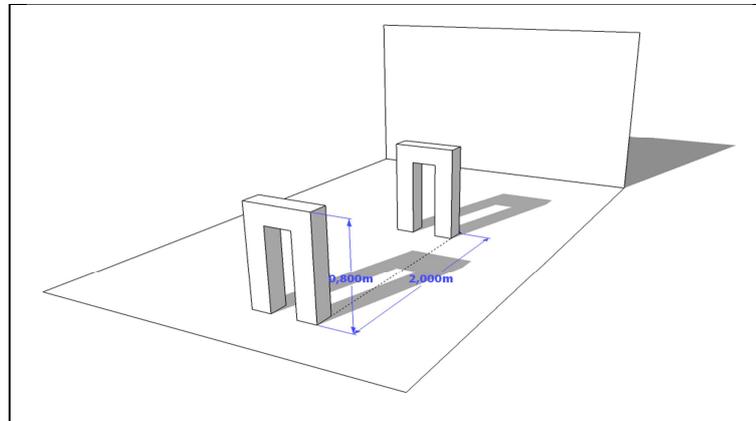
Vista 3D de los dos banco de concreto para la colocación de la columna semiterminada.
